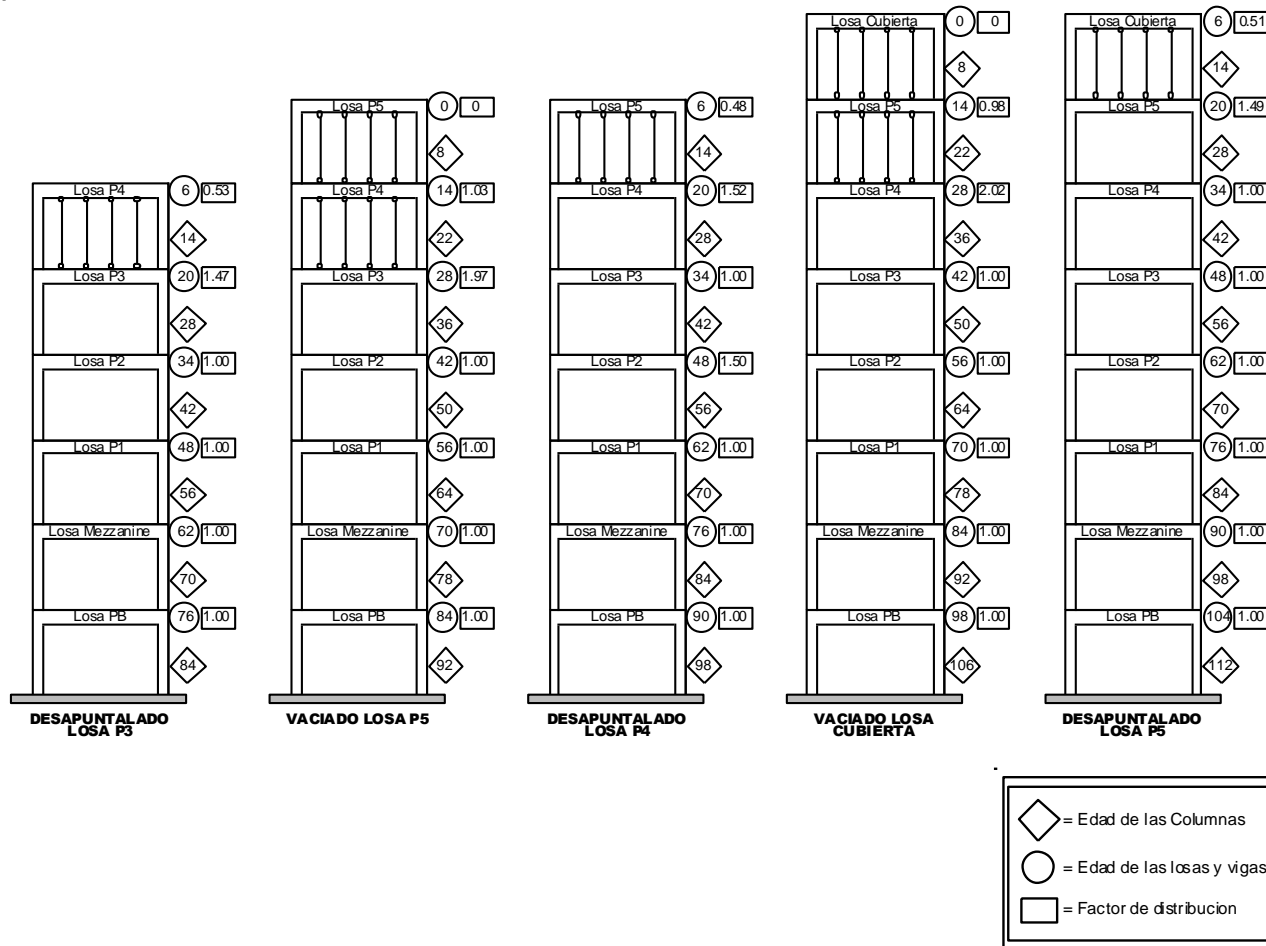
Etapas constructivas 11, 12, 13, 14 y 15 para un desapuntamiento de losa y viga a los 20 días.
